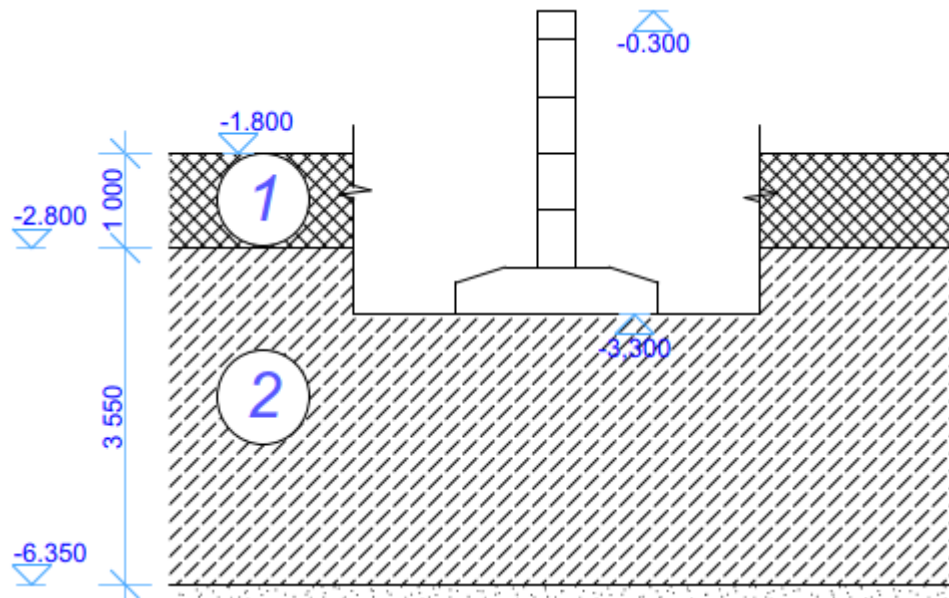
Положення фундаменту мілкого закладання у ґрунті
